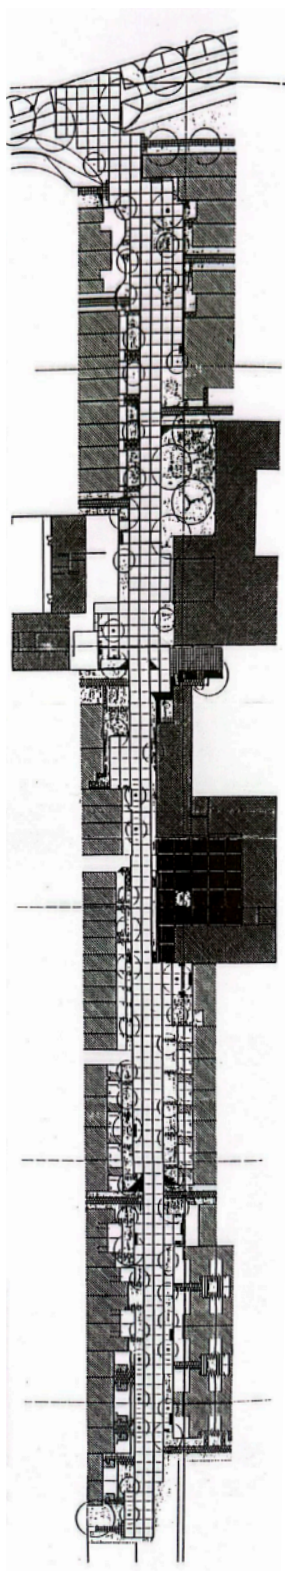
Planta de la alameda: paseo central o calle peatonal
